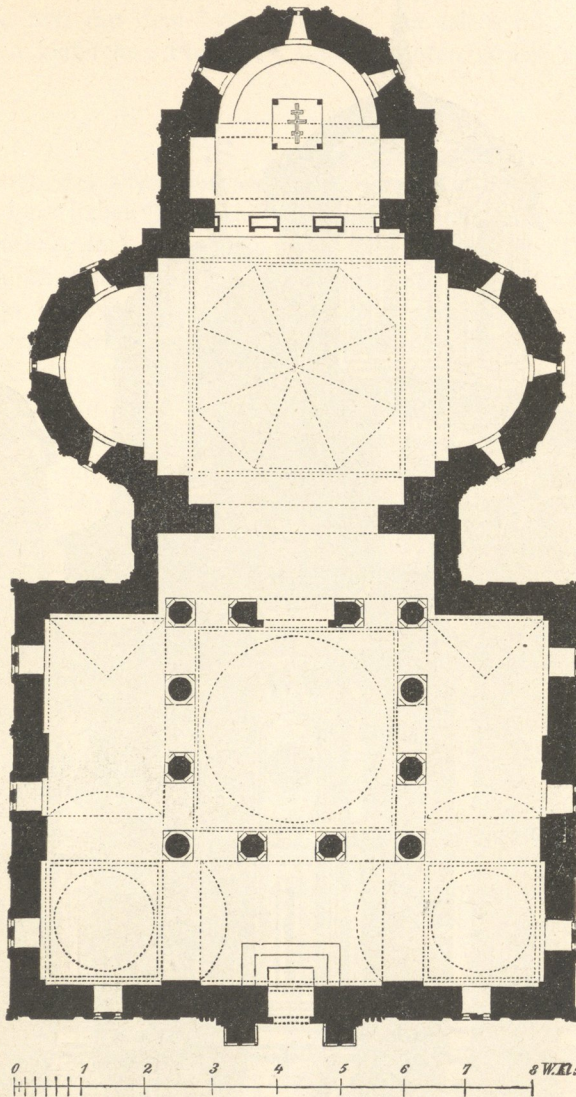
Grundriß der Klosterkirche in Kurtea d'Argyisch.
